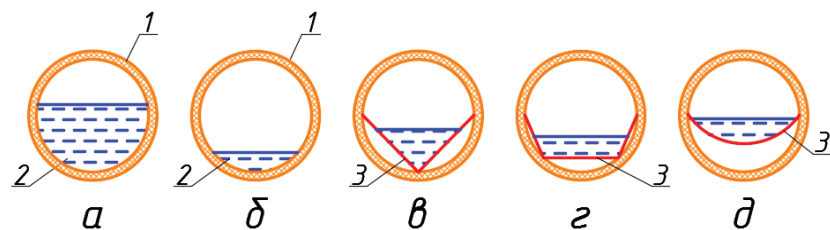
Устройство вкладыша на заливаемом участке трубопровода: а – сечение трубопровода при проектном расходе; б – сечение трубопровода при сниженном расходе; в, г, д – сечения трубопровода с использованием вкладыша при сниженном расходе; 1 – трубопровод; 2 – сточные воды; 3 – полиэтиленовый вкладыш
